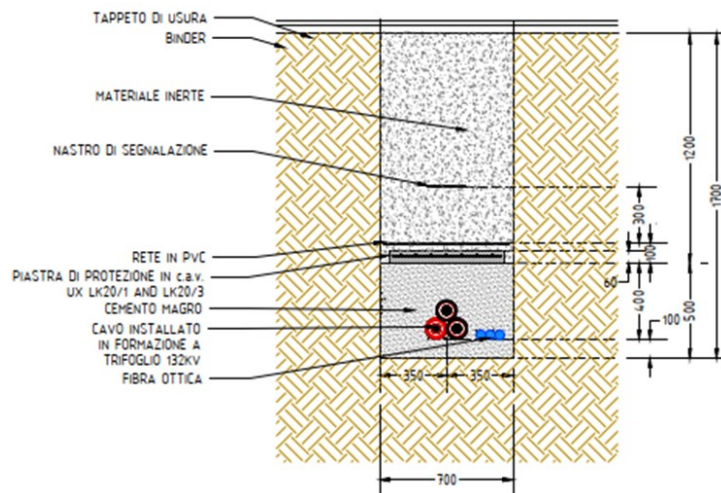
Sezione tipo su strada - Tratto di elettrodotto dalla Stazione di Trasformazione alla Stazione di Consegna.
